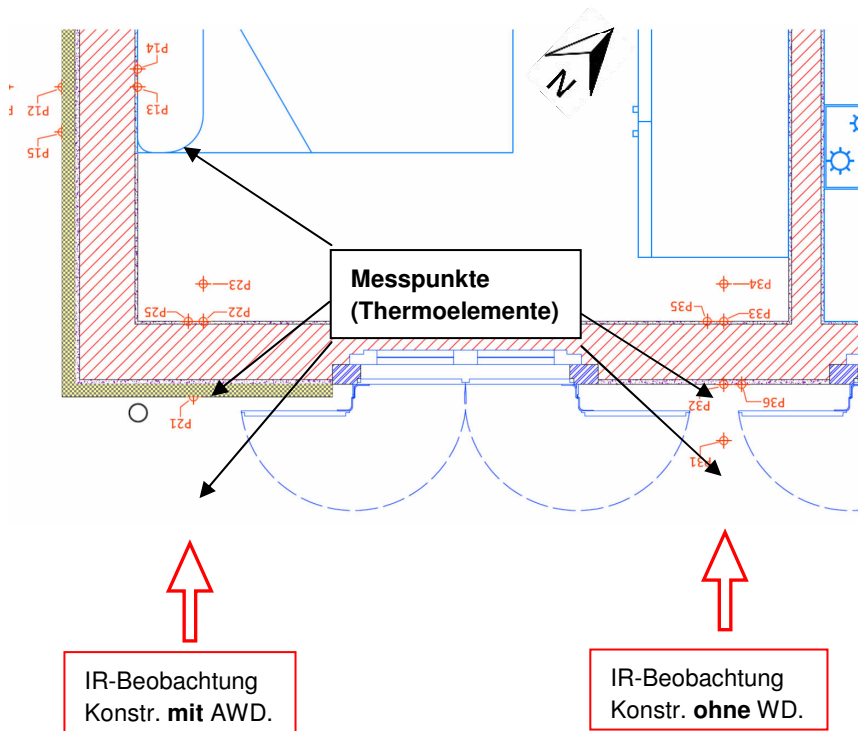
Grundriss des ausgemessenen Zimmers.
